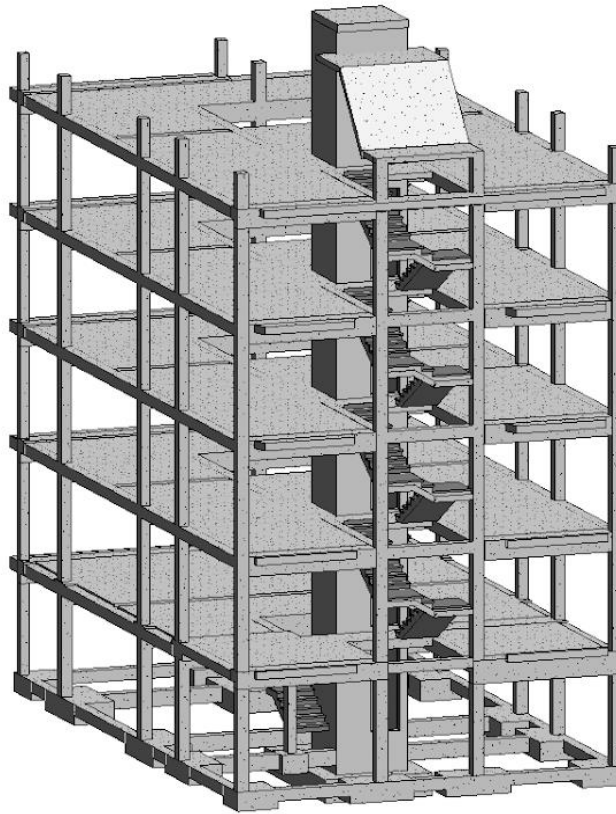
Modelado de la estructura en BIM. Fuente: Elaboración propia.
